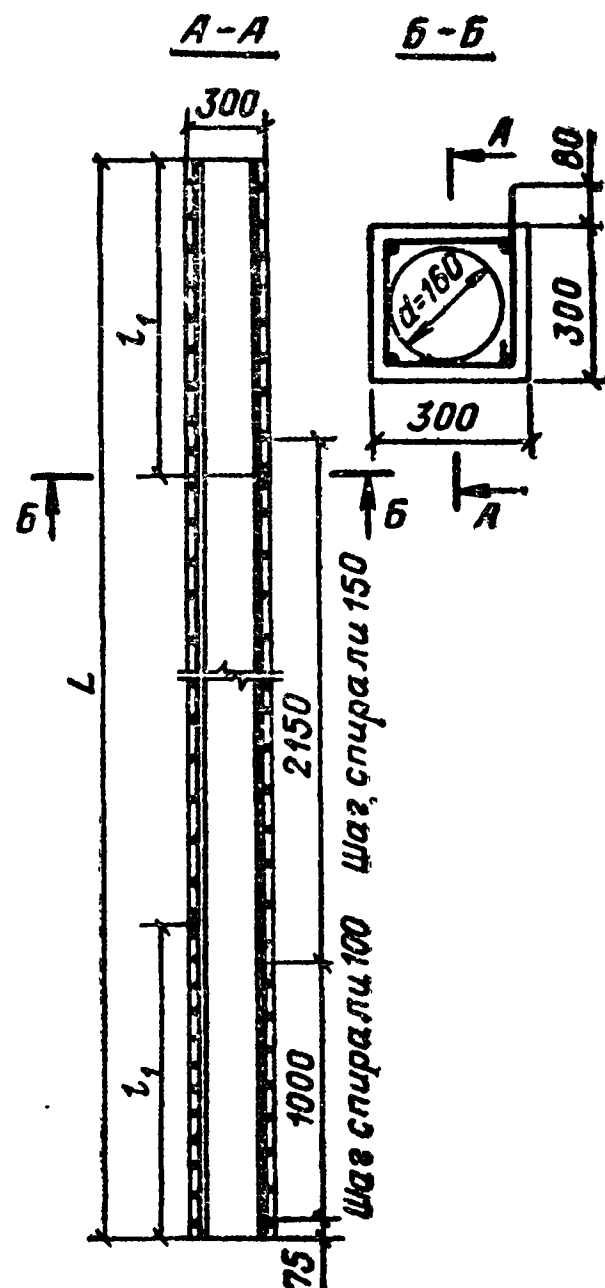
Железобетонная свая квадратного сечения с круглой полостью
